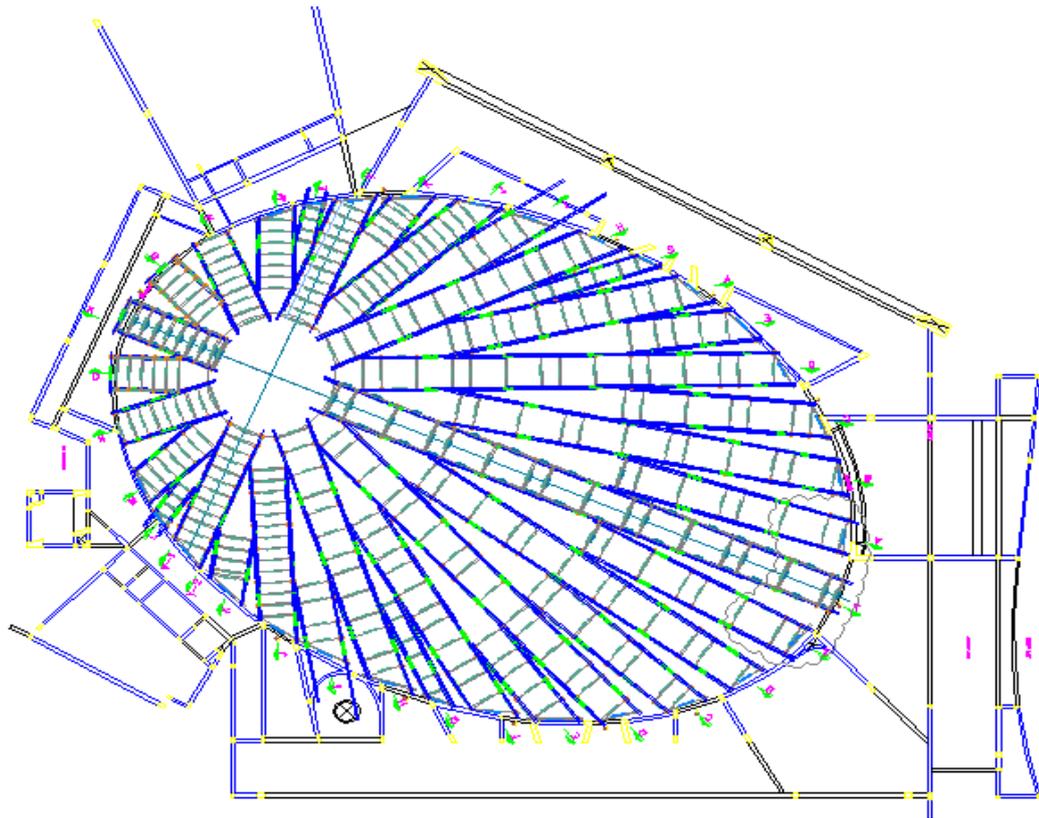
b. Vista en planta del sistema de andamiaje diseñado por Ulma.
